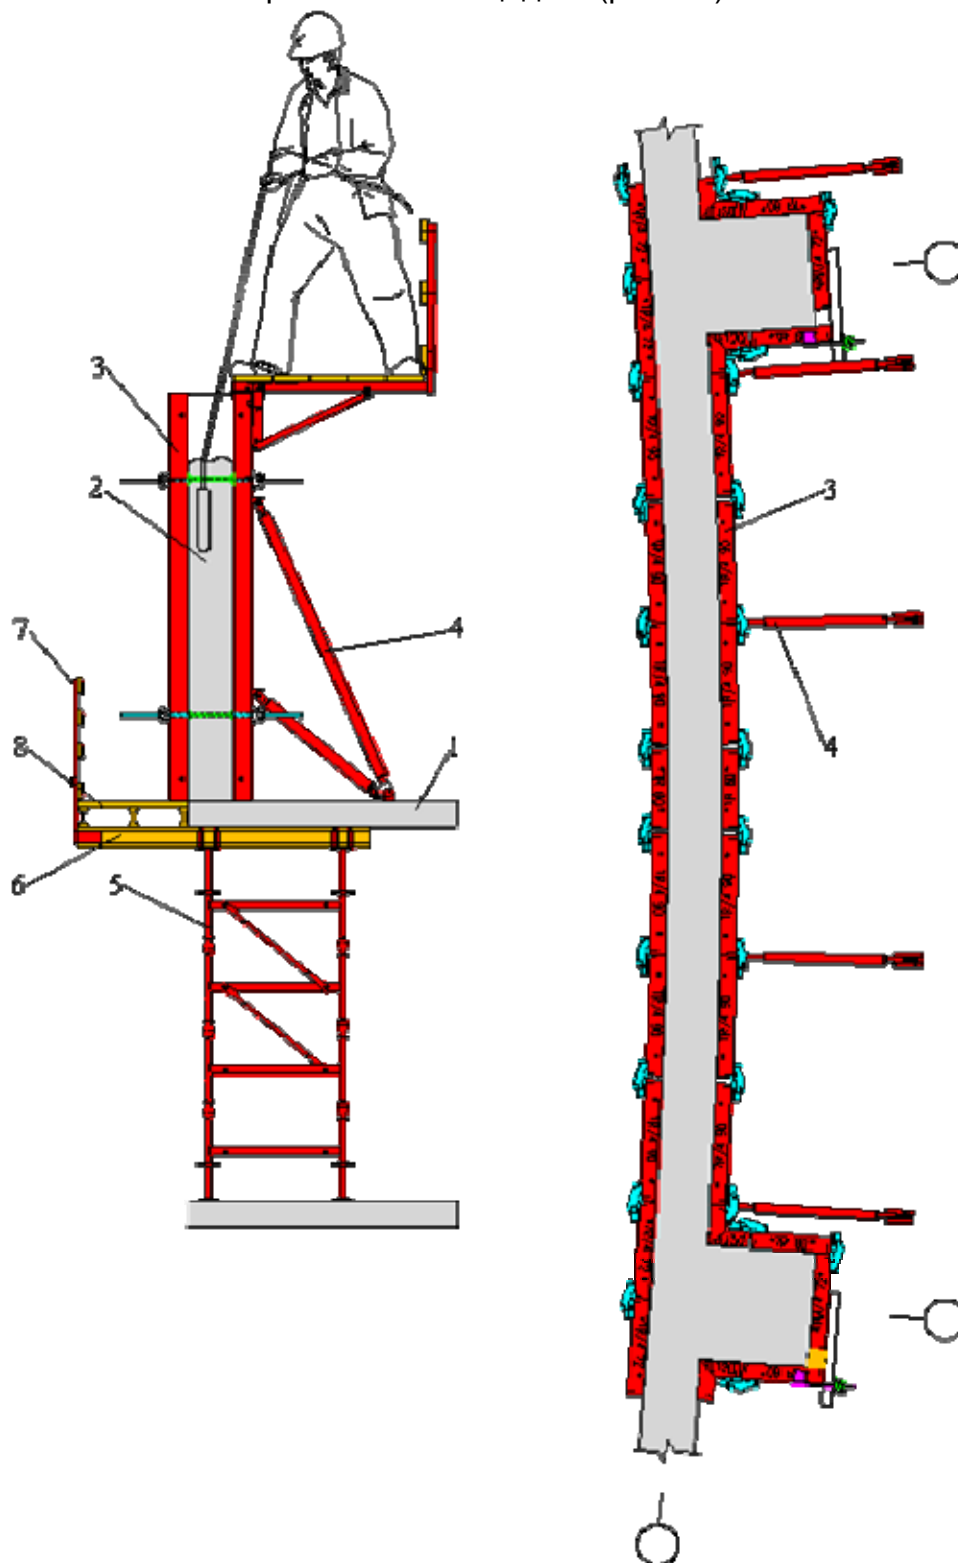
Возведение монолитных конструкций в зоне проемов в перекрытии
